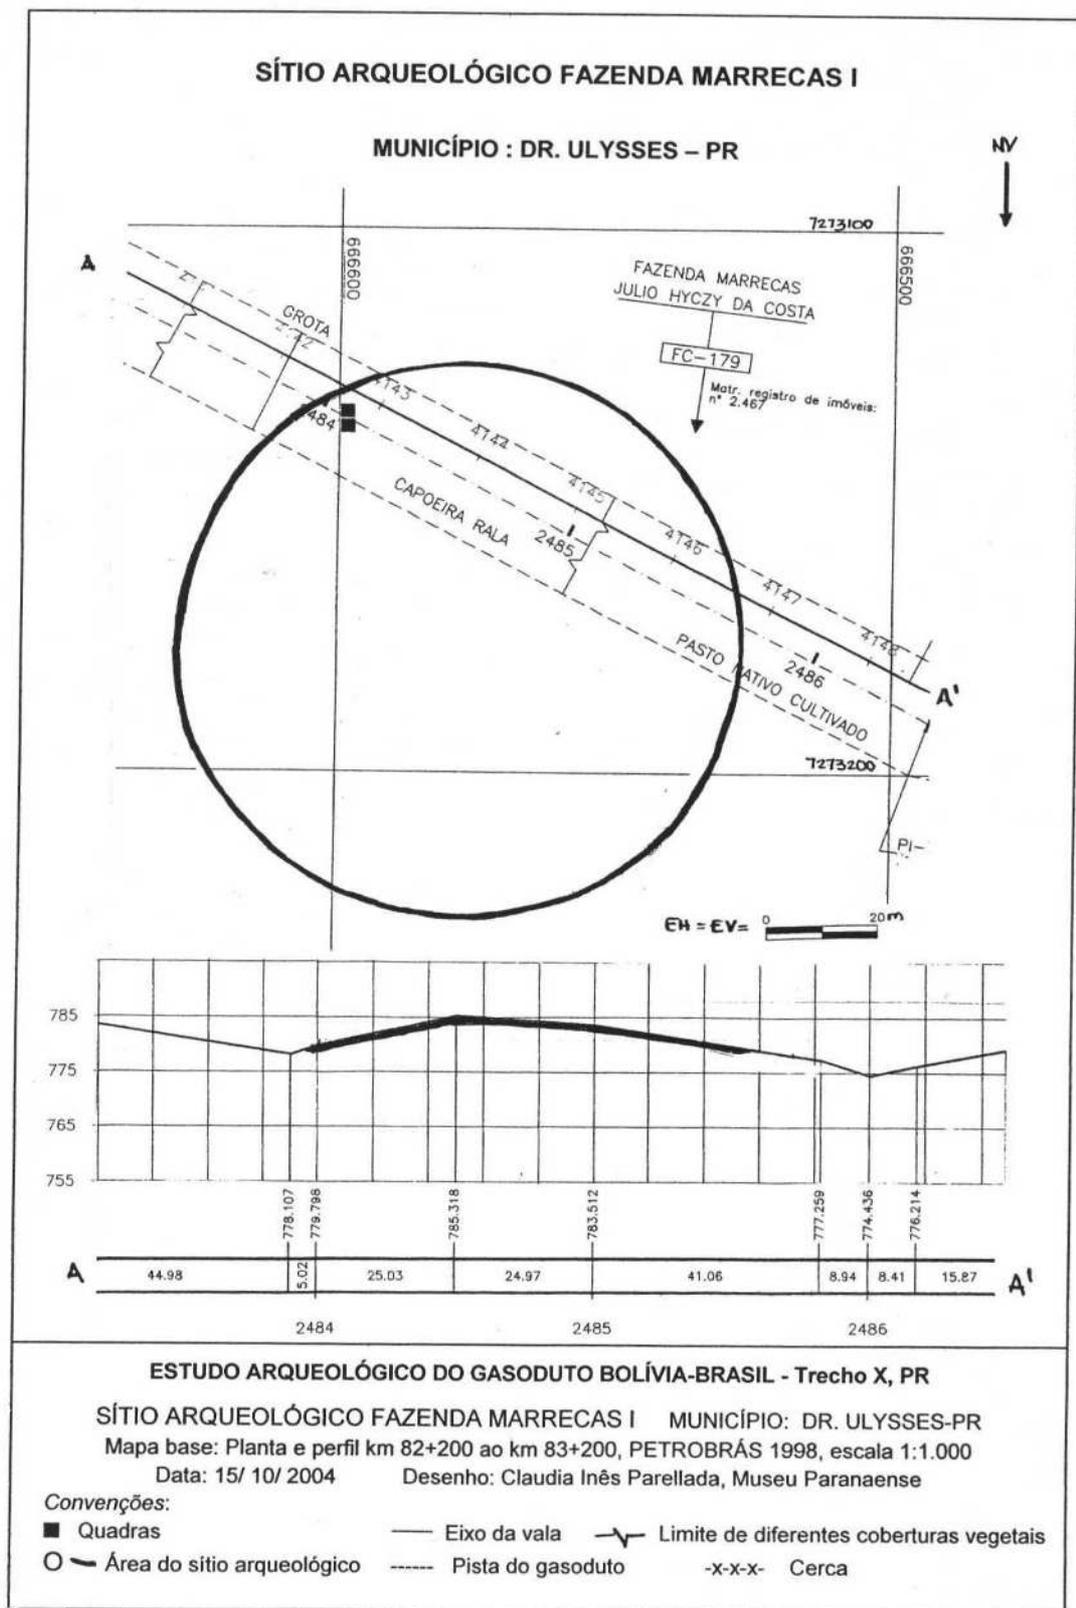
Planta e perfil topográfico do sítio Fazenda Marrecas 1, município de Dr. Ulysses, PR.
